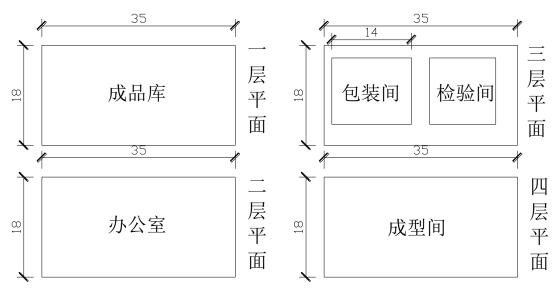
(a) 1#楼各层车间平面布置图(单位: m)
